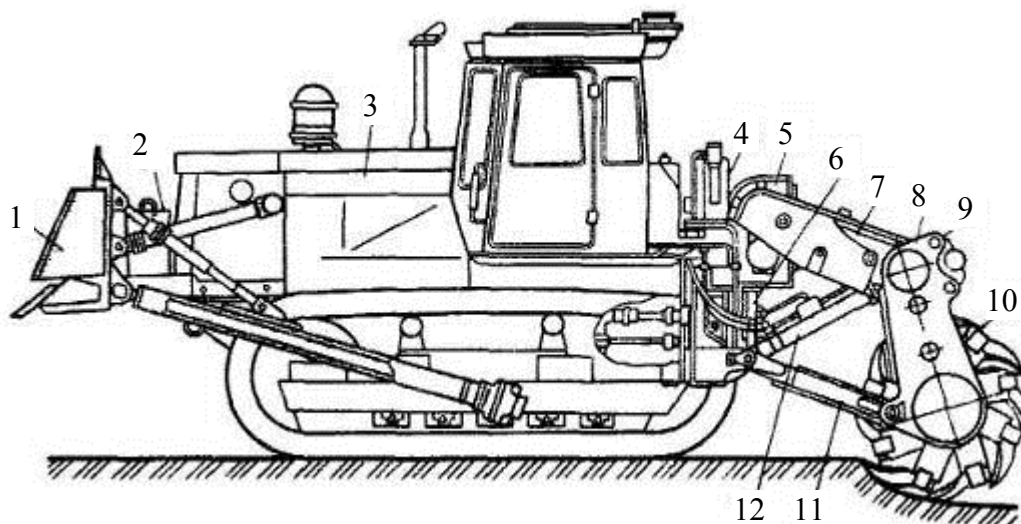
Землерийно-фрезерна машина: 1 – бульдозерний відвал; 2 – противага; 3 – гідросистема базового трактора; 4 – ходозменшувач; 5 – редуктор відбору потужності; 6 – запобіжна муфта граничного моменту; 7 – ланцюгові передачі; 8 – бортові редуктори; 9 – поперечна балка; 10 – привід фрези; 11 – нижня рама; 12 – гідроциліндри
